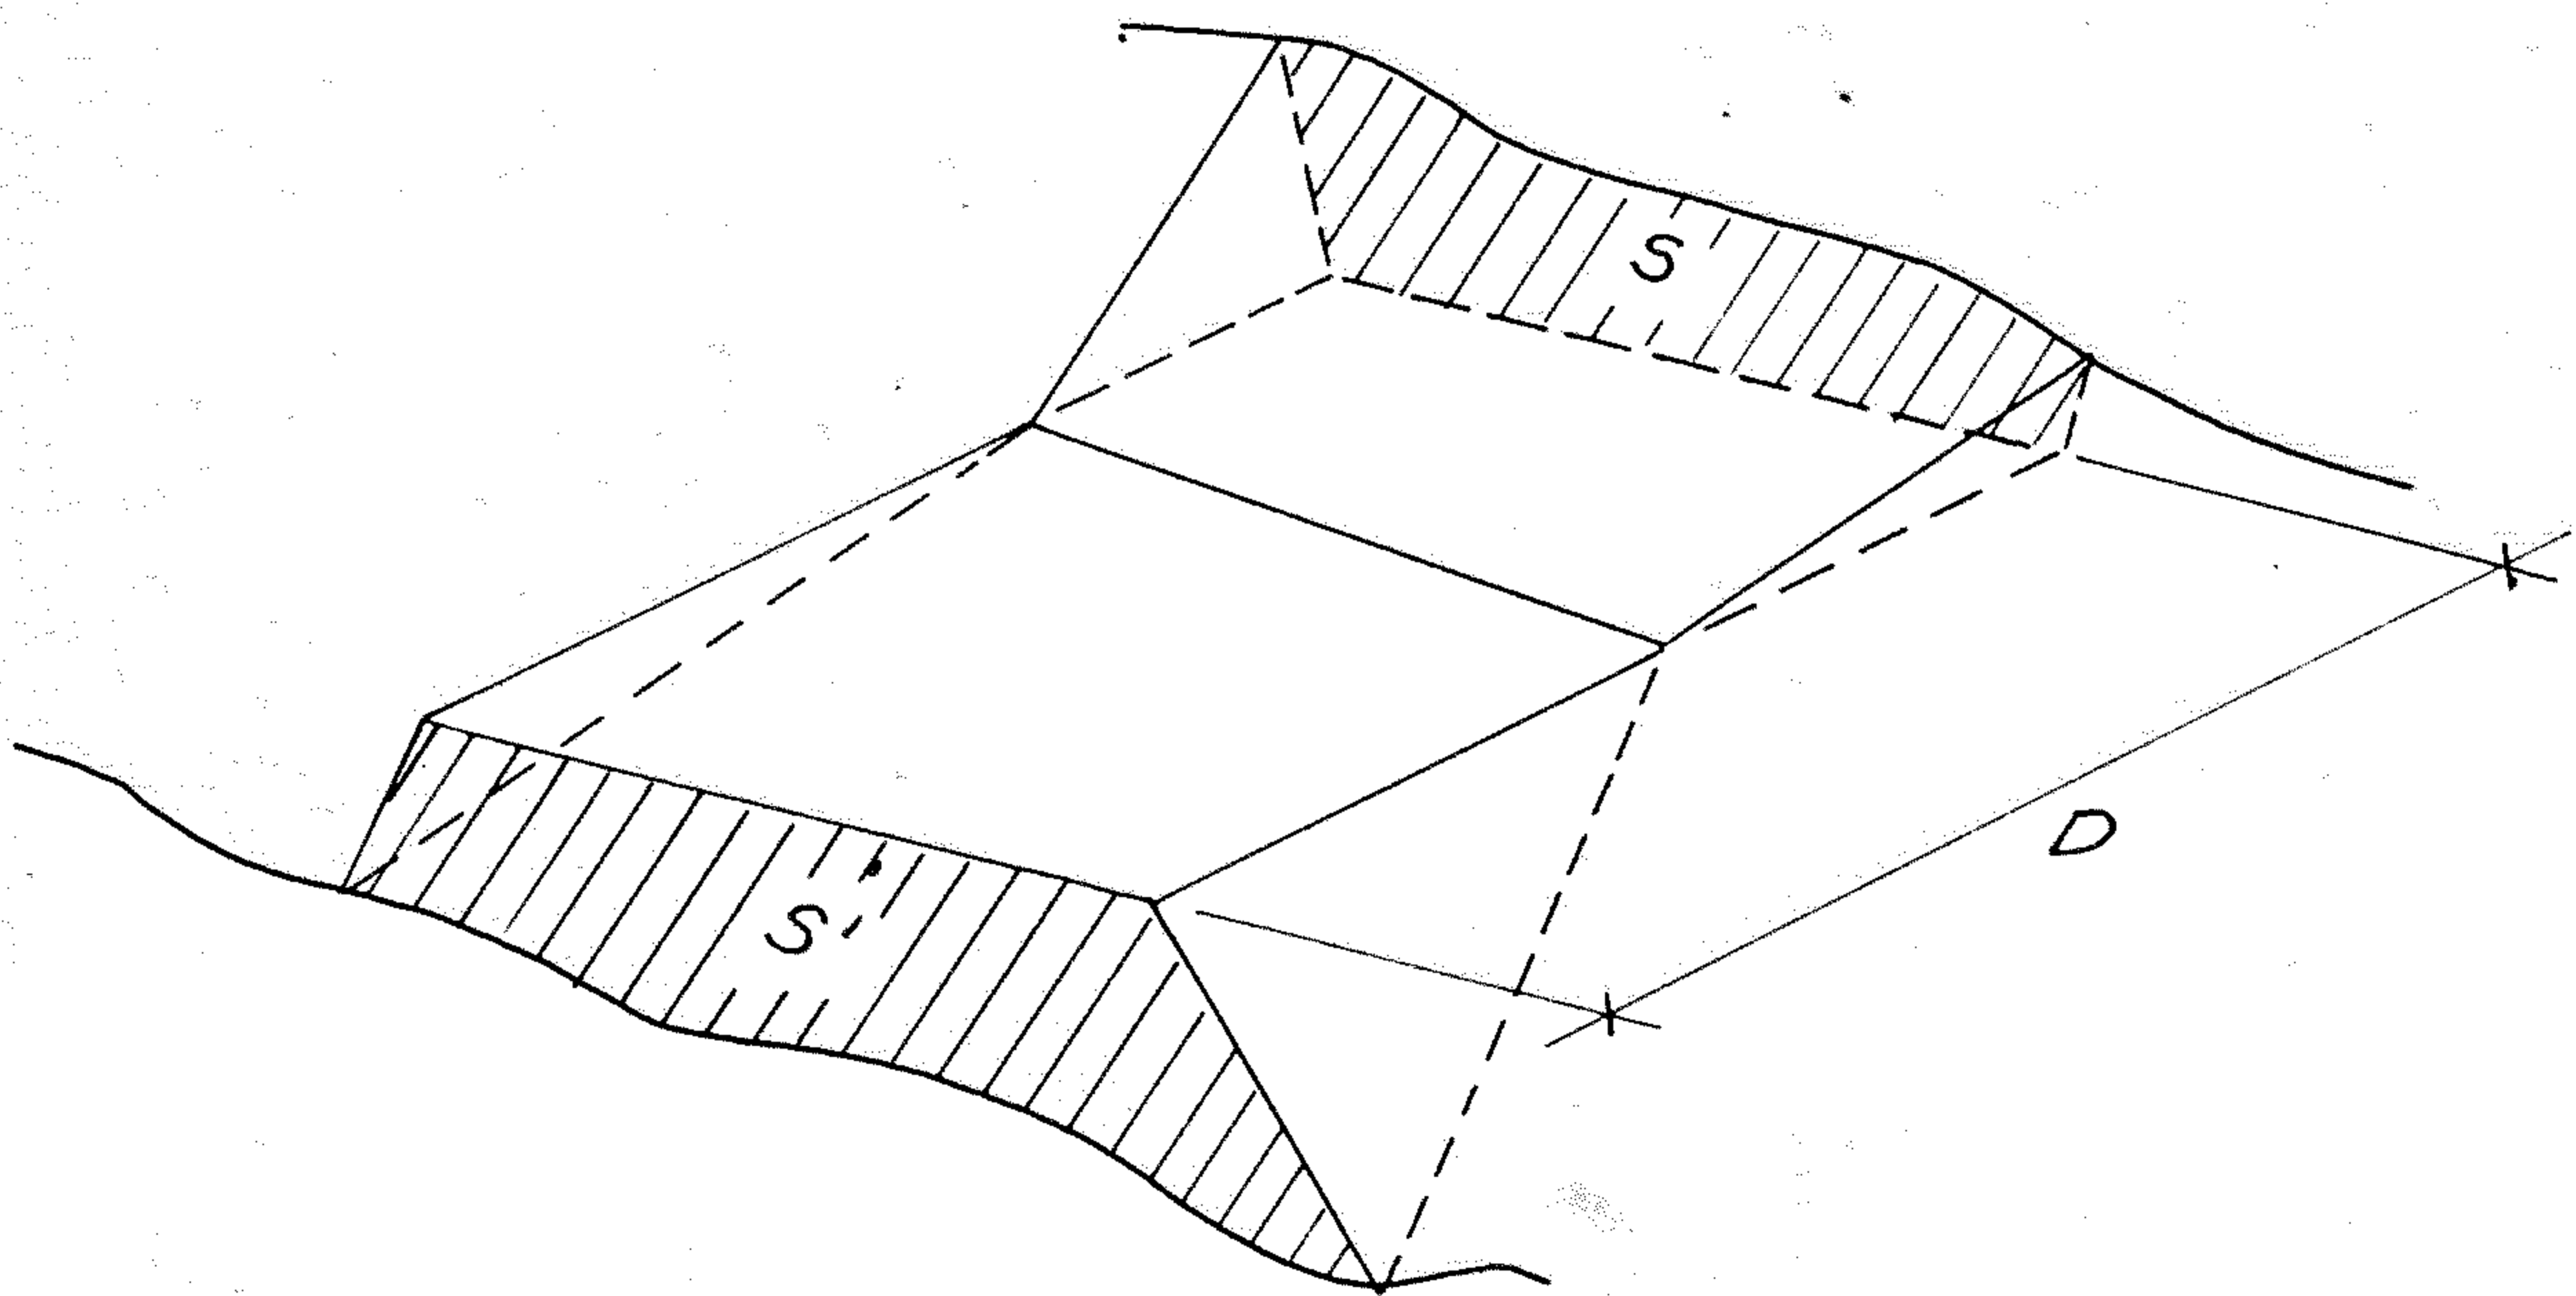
UNA SECCION EN CORTE Y LA OTRA EN RELLENO
